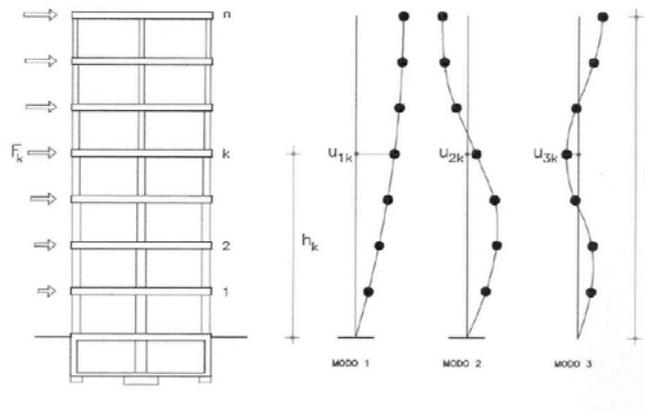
Modos de vibración en modelos planos de estructuras de pisos.
